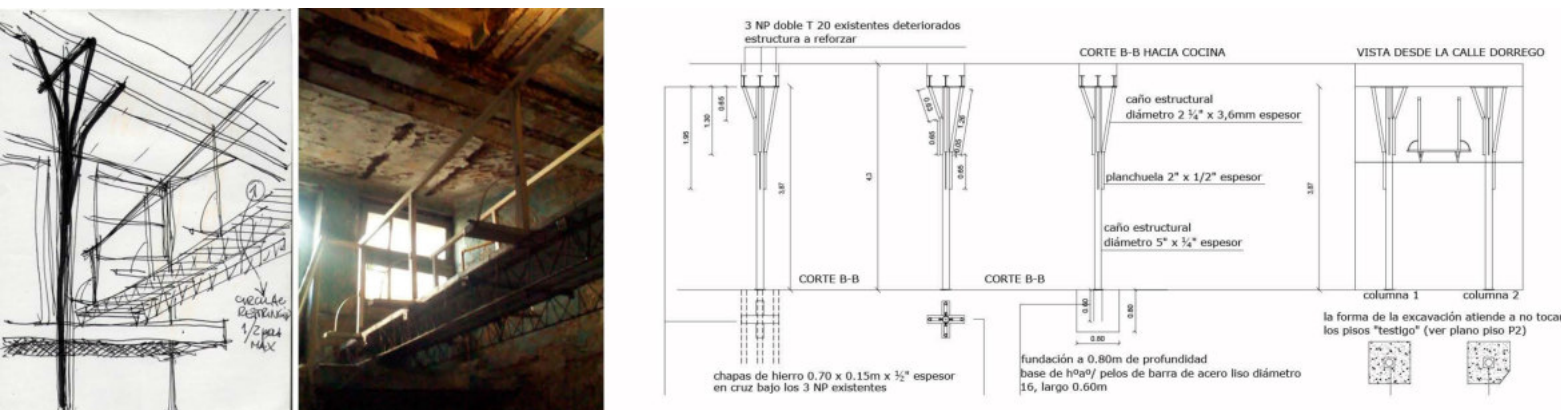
Croquis columna para apuntalamiento viga principal. Ph: Alejandra Buzaglo, 2014. Descripción de los componentes de la columna en espejo a ambos lados del puente.
